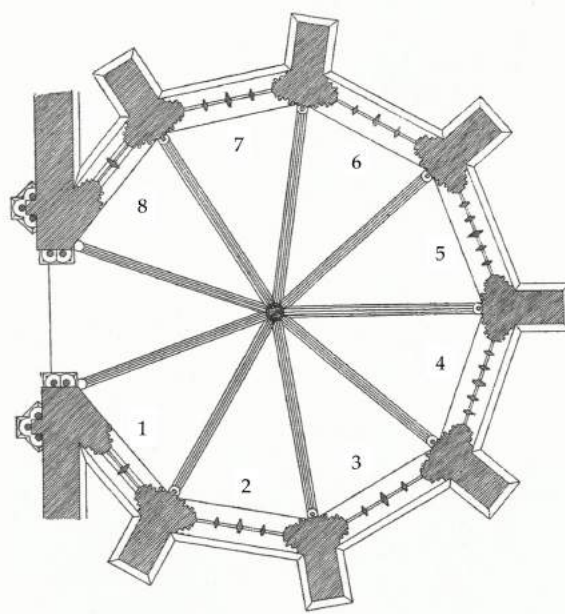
Grundriss Brunnenhaus Heiligenkreuz
